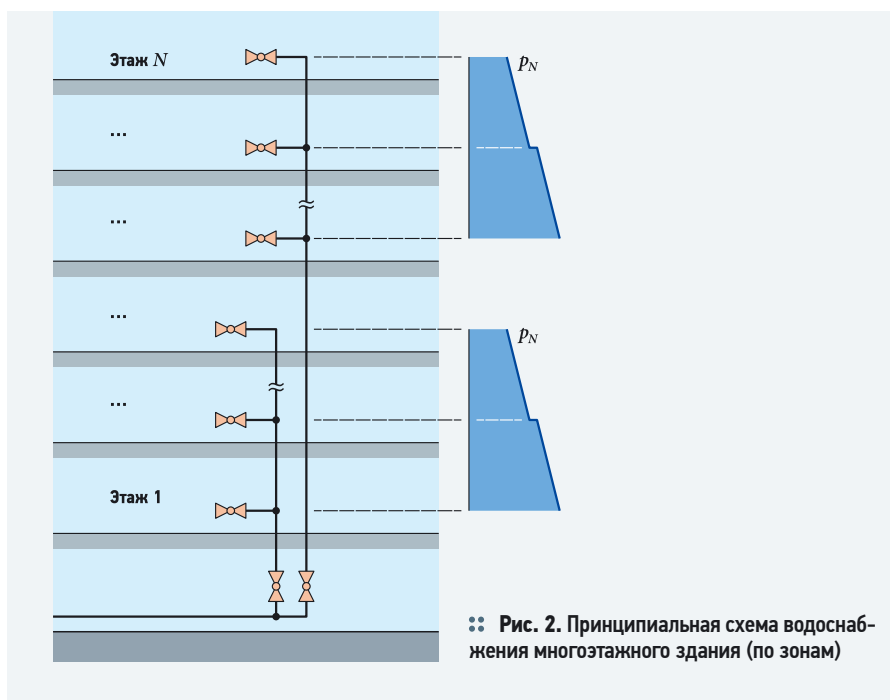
Принципиальная схема водоснабжения многоэтажного здания (по зонам)
